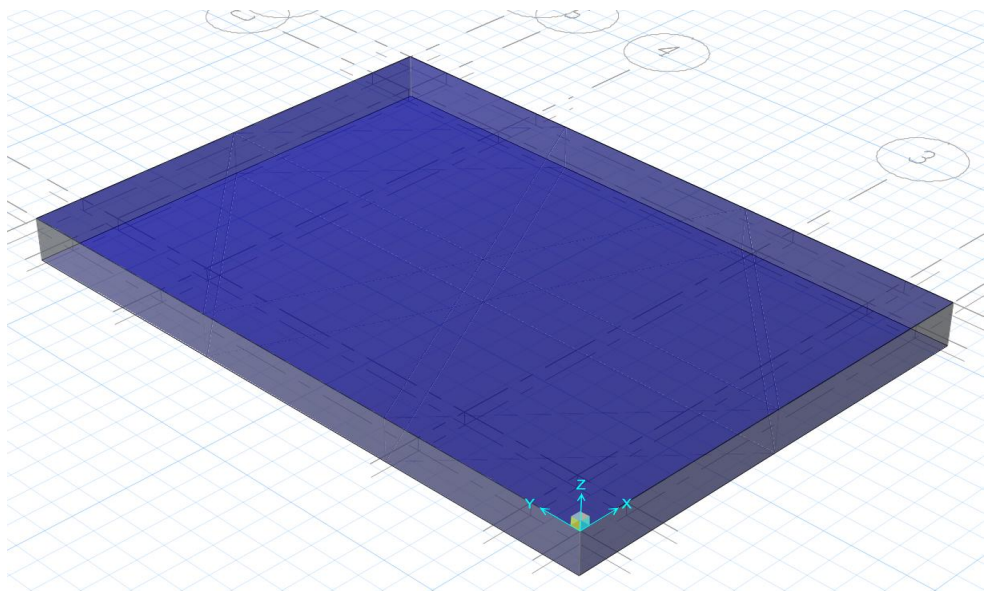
Planta y elevación cimentación de cisterna y tanque
